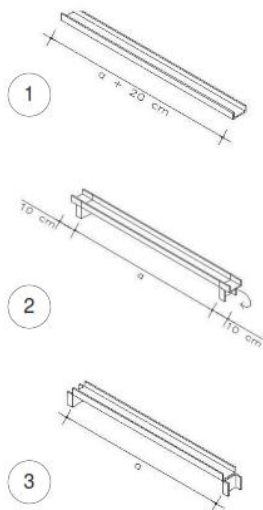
, Vanos en ventanas de muro estándar. (Fuente: propia del autor)
